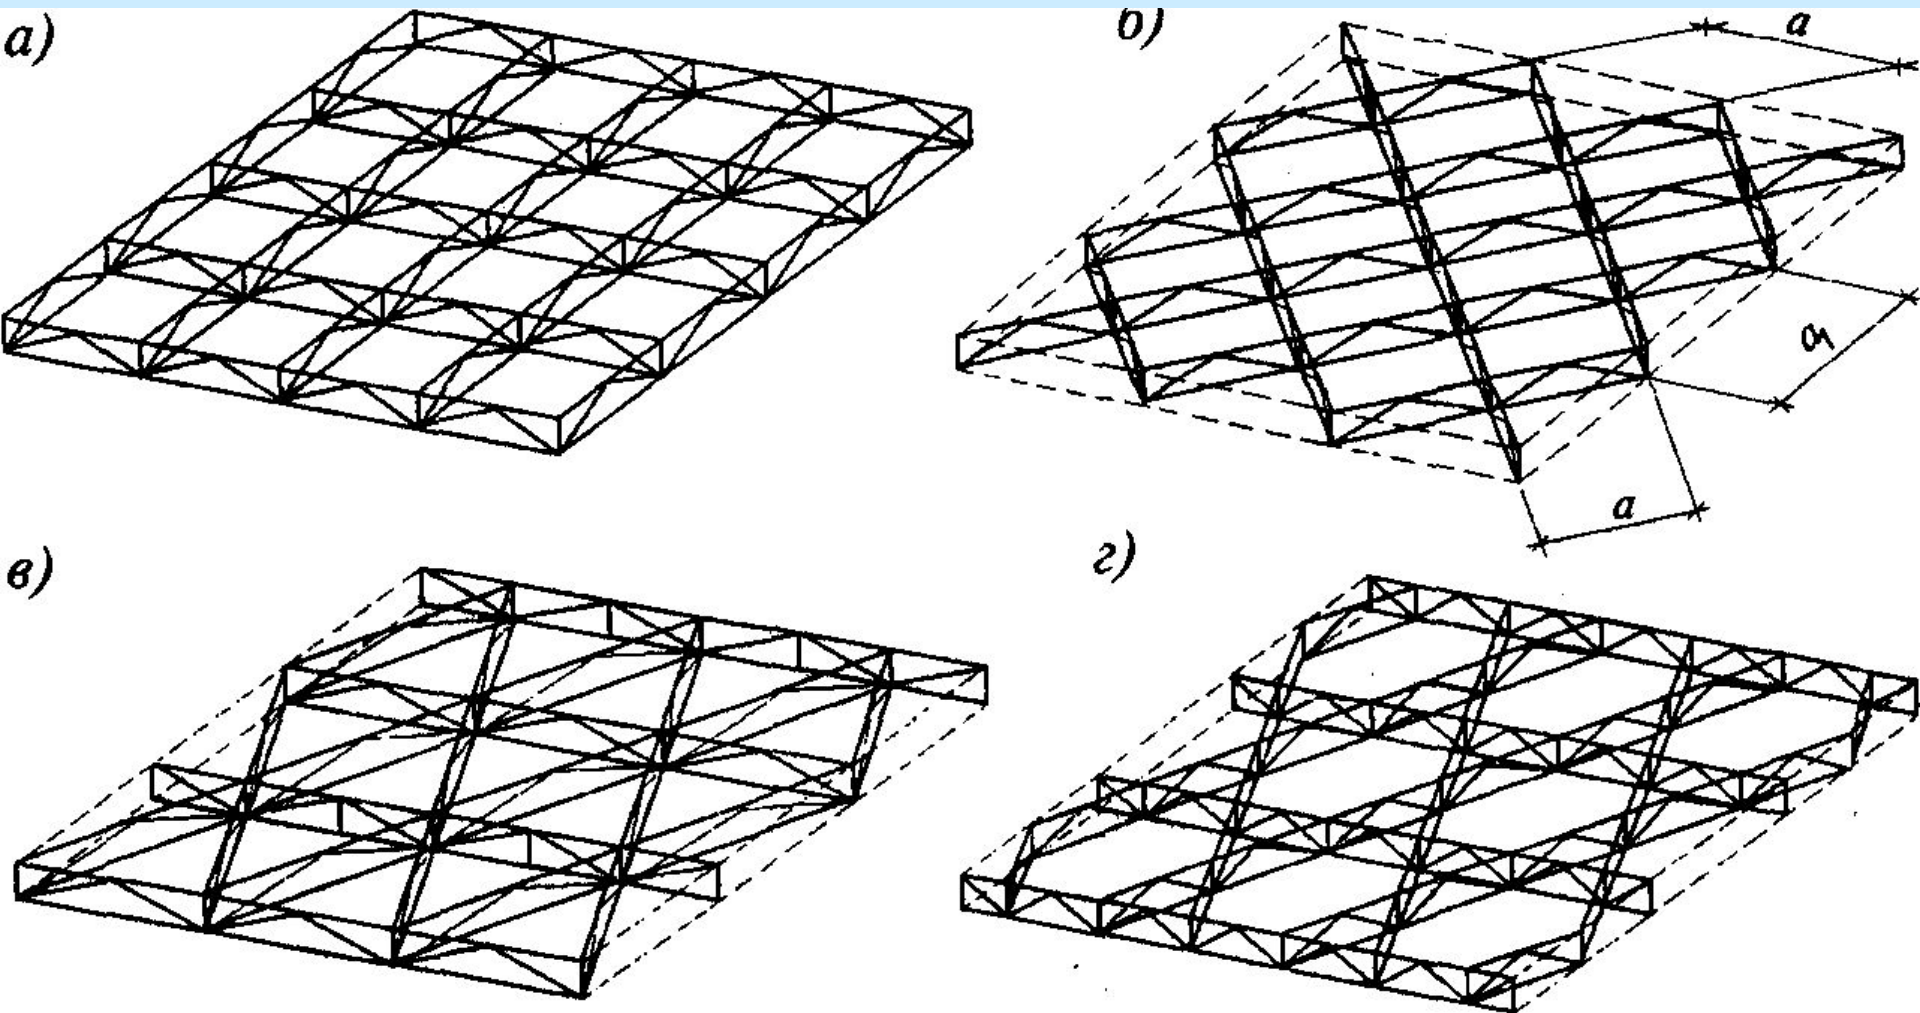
Схемы перекрытий из вертикальных перекрестных ферм:
